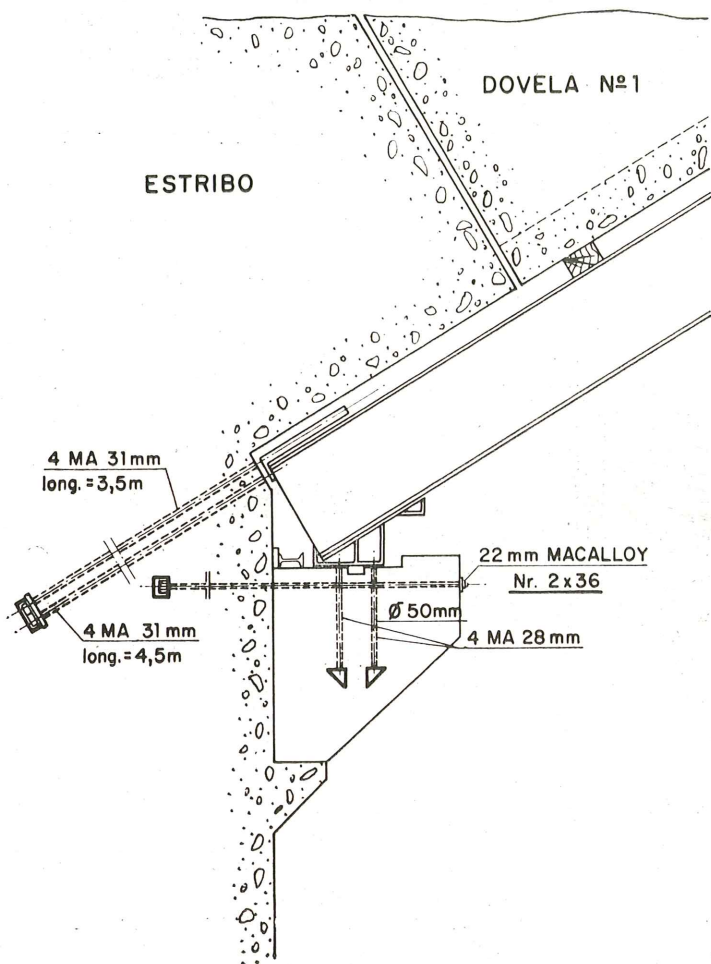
Empotramiento provisional de la cimbra en el estribo.
